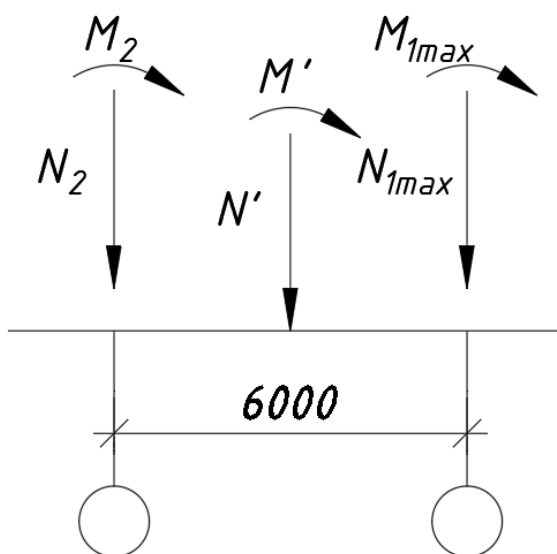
Схема приложения нагрузки от ветвей колонны рамы
